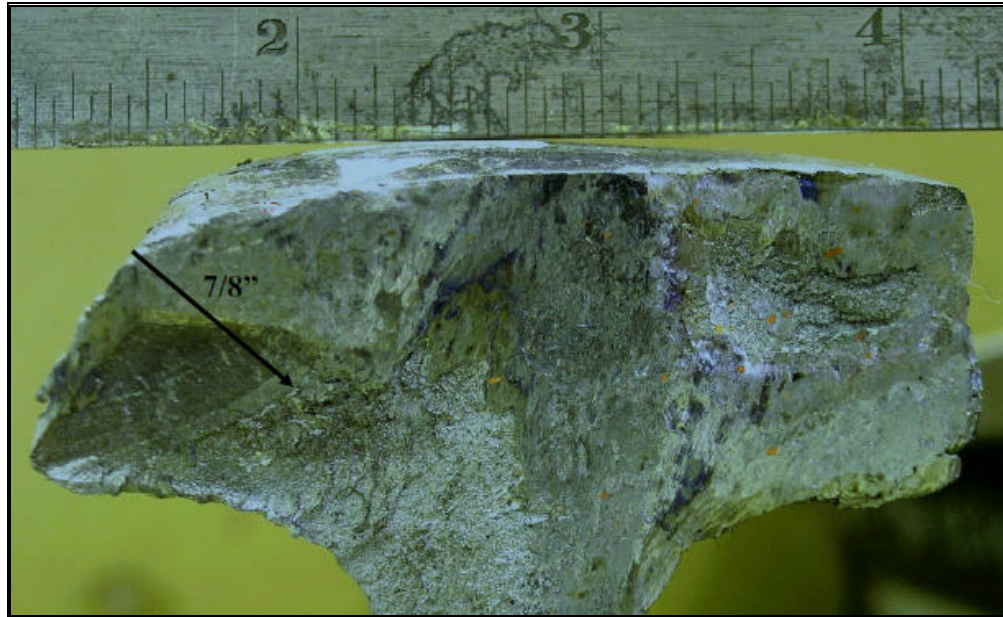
Gros plan de la face de rupture du côté ouest de la rupture A-A, montrant la fissuration de fatigue (FF) sur la face intérieure du rail.
